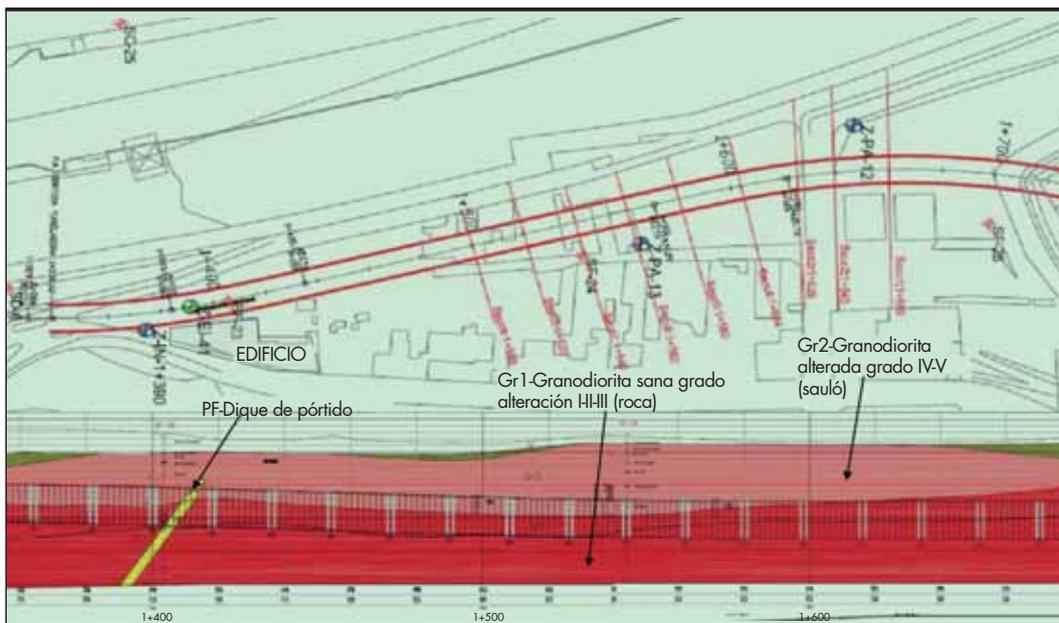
Planta y perfil geológico del tramo de Can Peixauet en terreno mixto entre el P.K. 1+640 y 1+370. Túnel de la Línea 9 del Metro de Barcelona en Santa Coloma.
